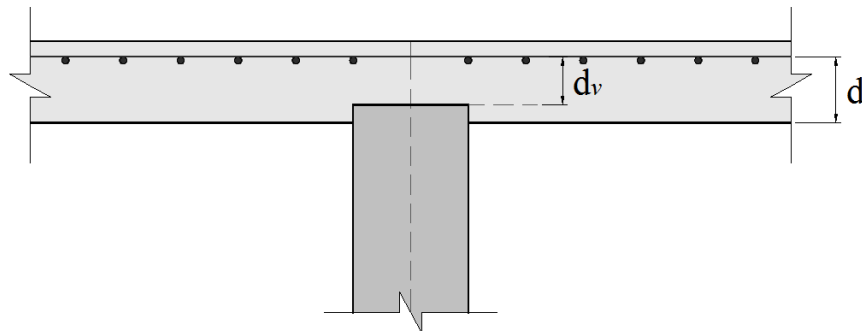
Altura útil efetiva da laje considerando a penetração do pilar na laje ( $d_v$ ) e altura útil da laje ( $d$ )
